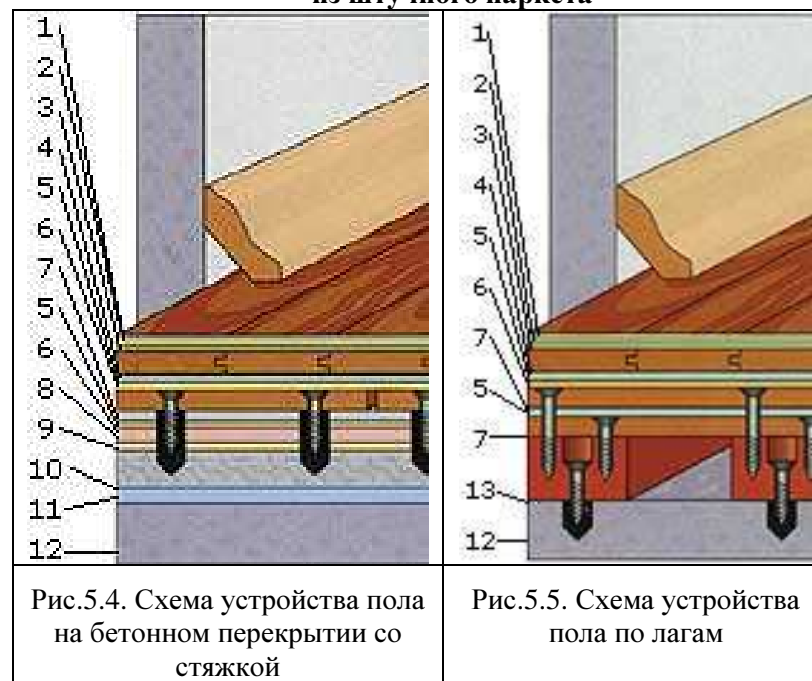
Схема устройства пола на бетонном перекрытии со стяжкой
